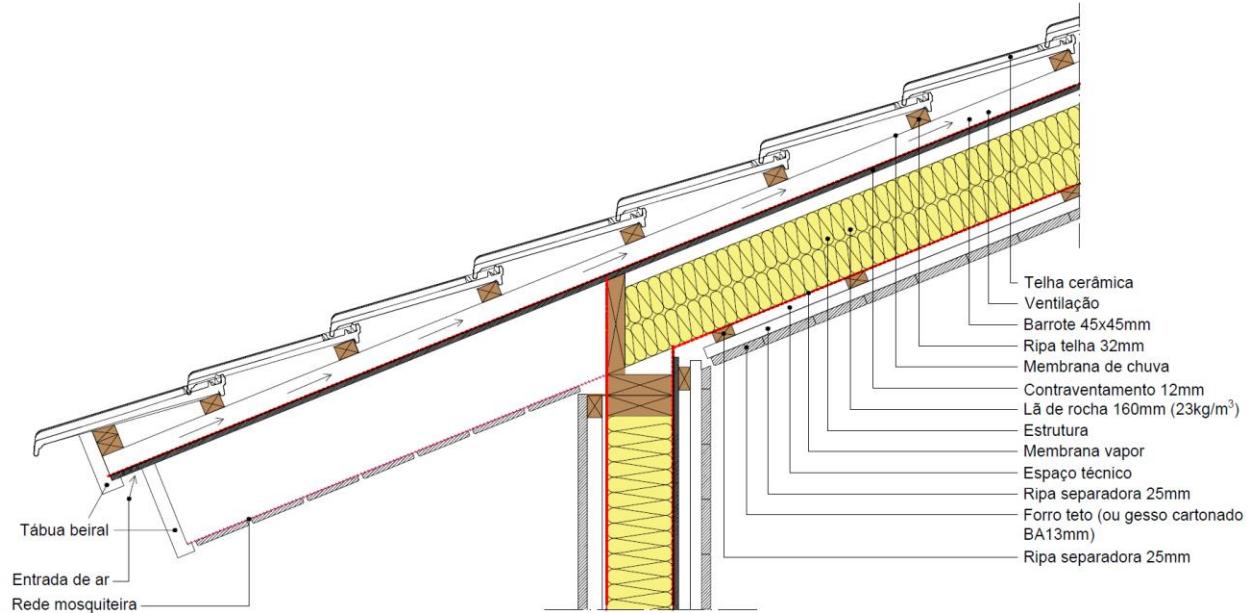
Características geométricas da secção transversal da cobertura “Timber Frame System”.
